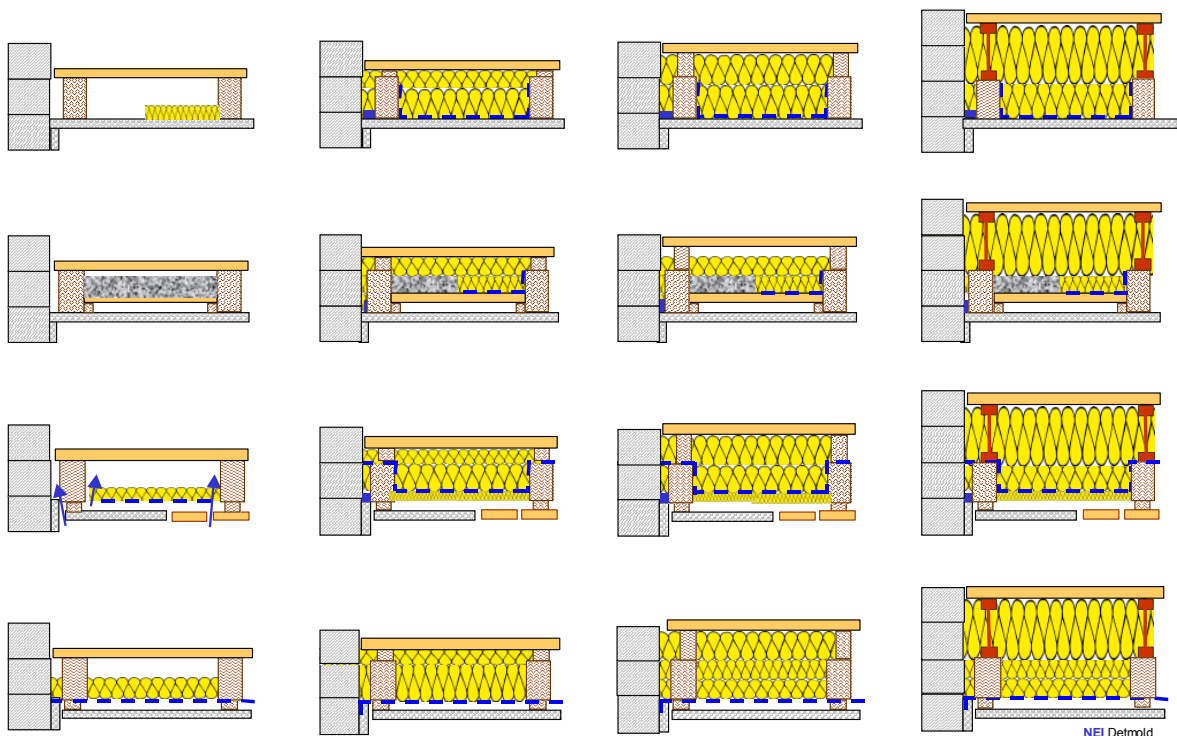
Holz-Kehlbalkendecken mit Unterbekleidung, Sanierungsvarianten von oben
